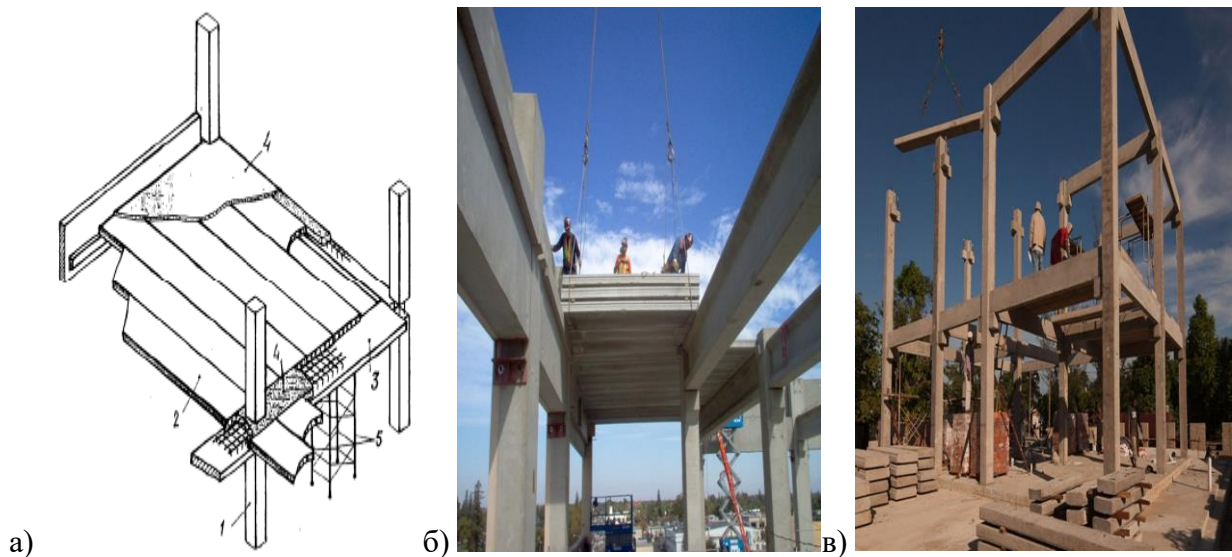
Схема перекрытий системы Ducore: а) 1 – колонна, 2 – многопустотная плита, 3 – нижний сборный элемент балки, 4 – монолитный бетон; Монтаж несущих конструкторских элементов сборного железобетонного каркаса, США: а) штат Калифорния, б) штат Флорида
